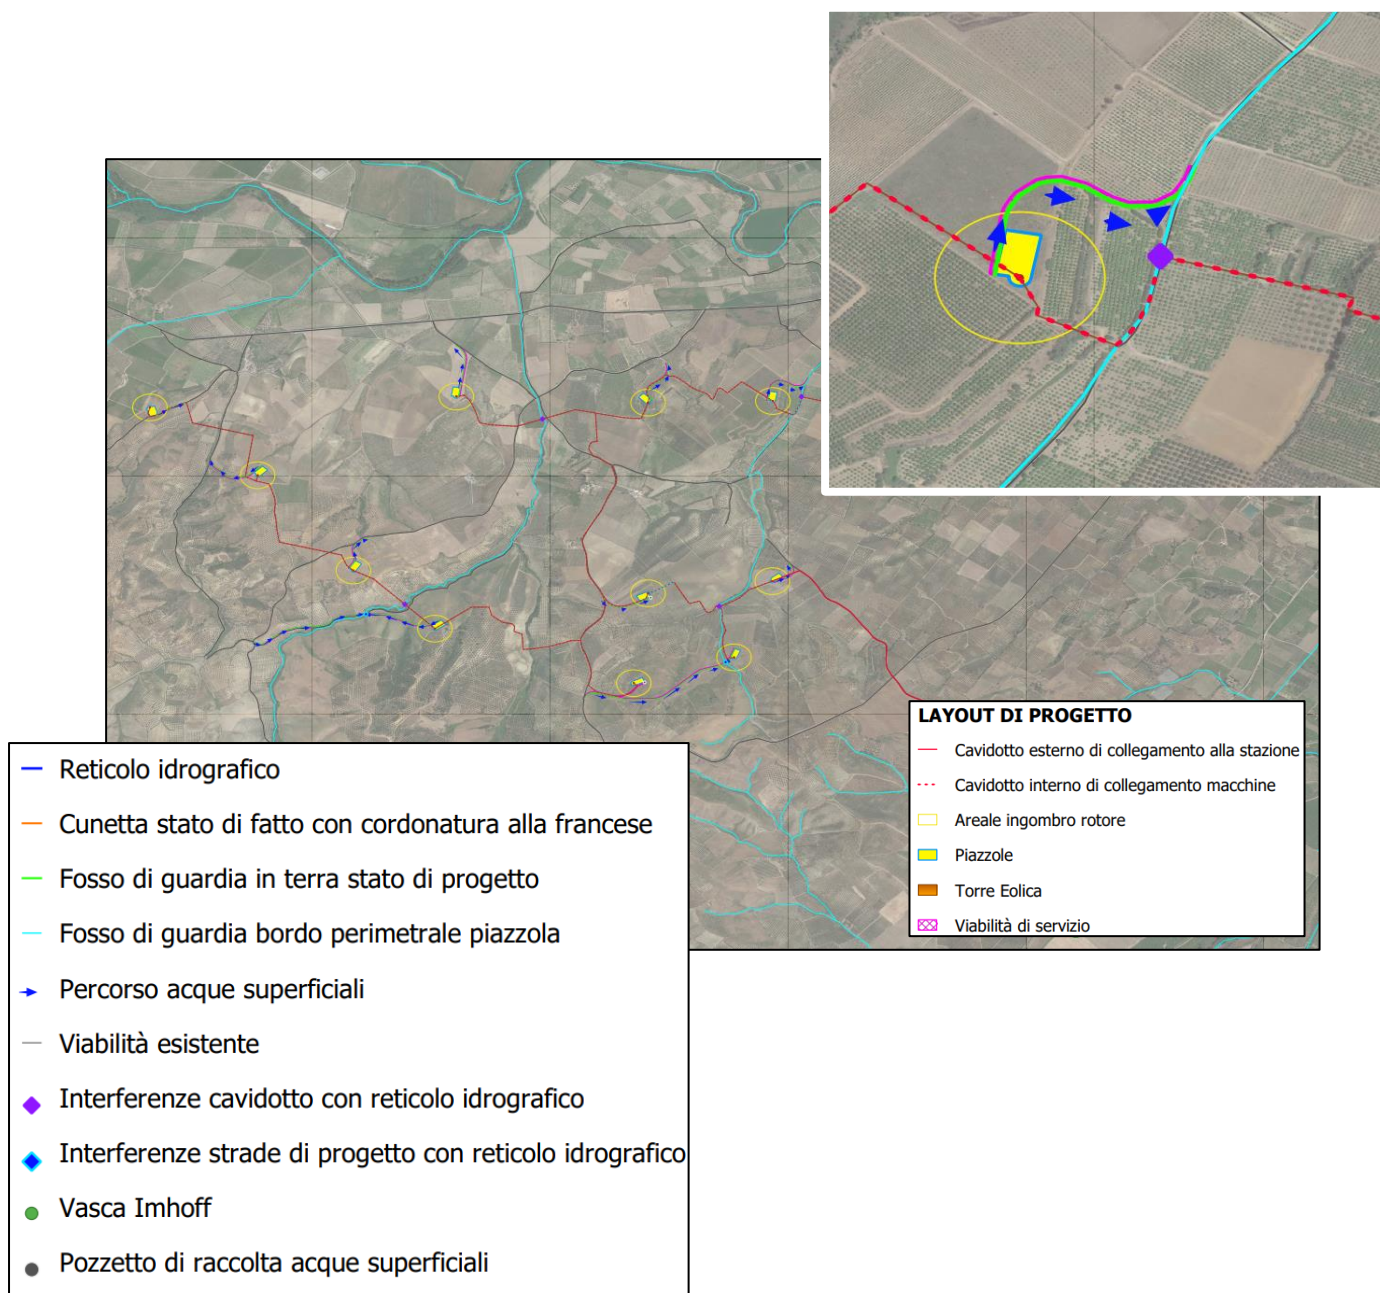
Planimetria stato di progetto con deflusso acque superficiali
